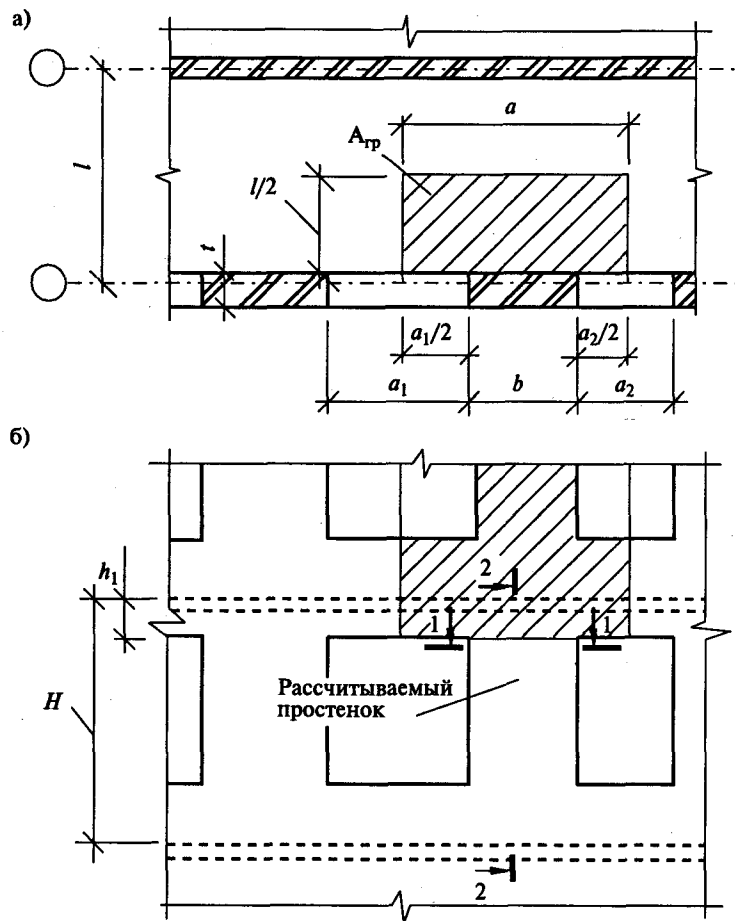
К расчету простенка: а) участок плана здания с грузовой площадью:  $a$  — ширина грузовой площади (расстояние между серединами оконных проемов);  $a_1$ ,  $a_2$  — ширина оконных проемов;  $v$  — ширина простенка;  $t$  — толщина стены; б) участок фасада:  $H$  — высота этажа;  $h_1$  — расстояние от плиты перекрытия до верха оконного проема
